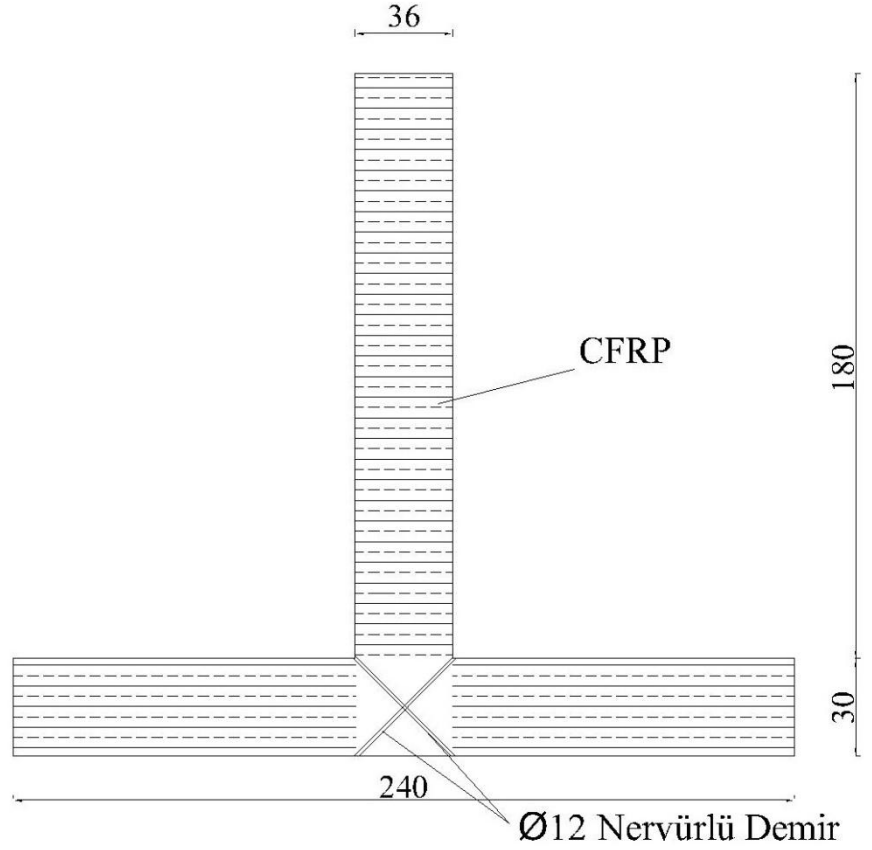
Referans-1 elemanı geometrisi, donatı detayları ve kesit detayları
